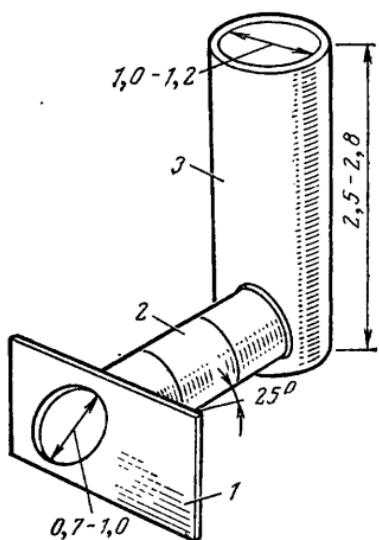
Вариант выносного аварийного выхода из железобетонных элементов:
